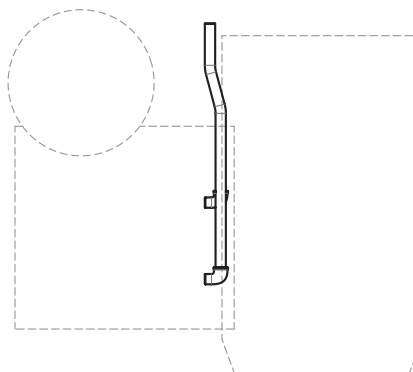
Montare le tubazioni idrauliche – vista dall'alto
